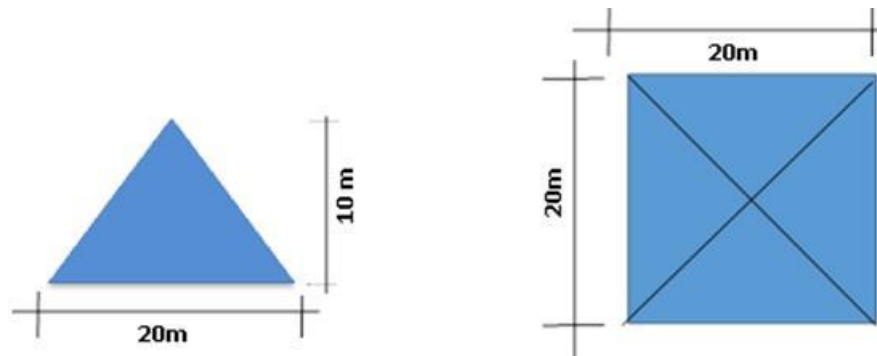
A la izquierda, vista de frente y a la derecha vista de planta de la pila
